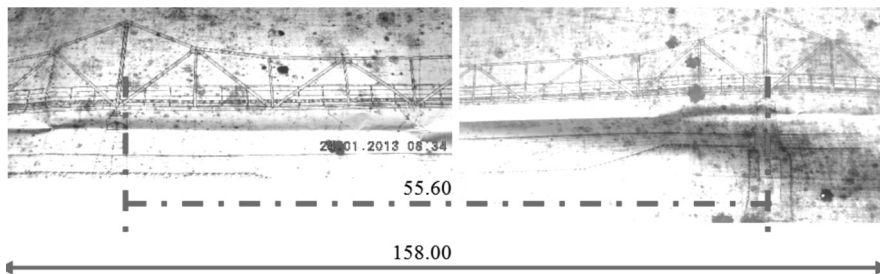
Planos de obra. Sección longitudinal. Fuente: Dirección de Hidráulica Sección Dolores.
